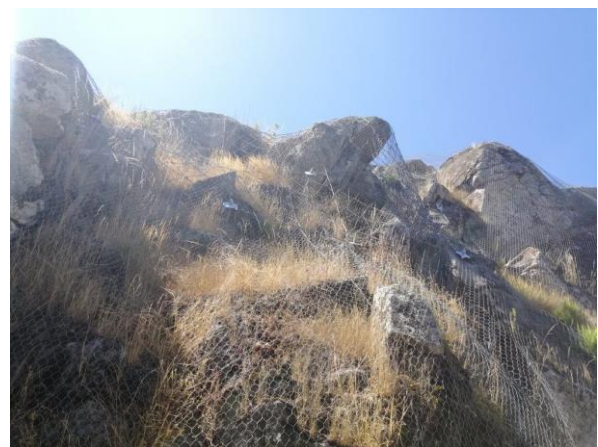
Aplicação de painéis HEA e pregagens em talude de escavação.
